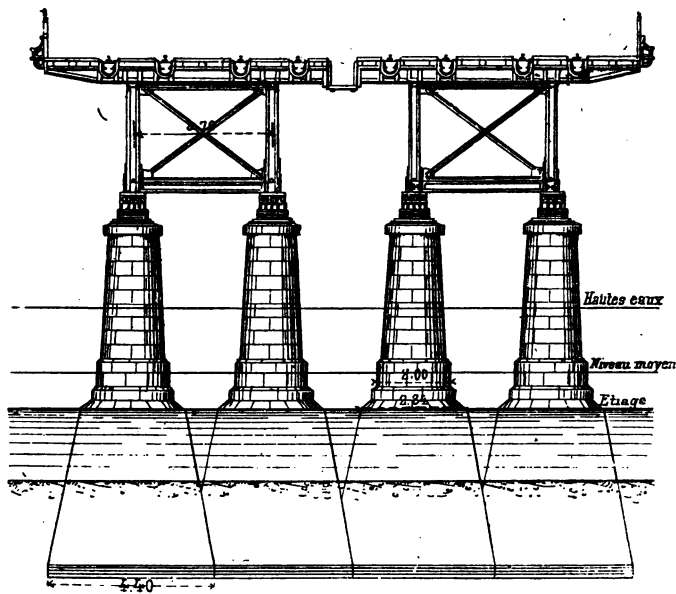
Coupe transversale du pont sur la Sprée, près du pont de Bellevue.
